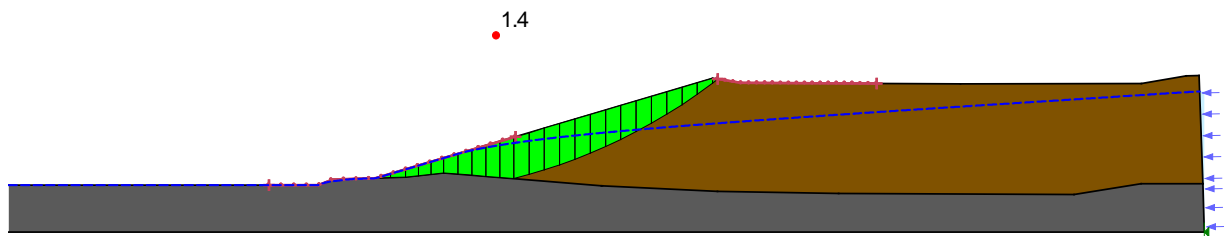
Stabilité court terme, pente d’excavation 3,5H:1V, excavation dans des sols argileux
